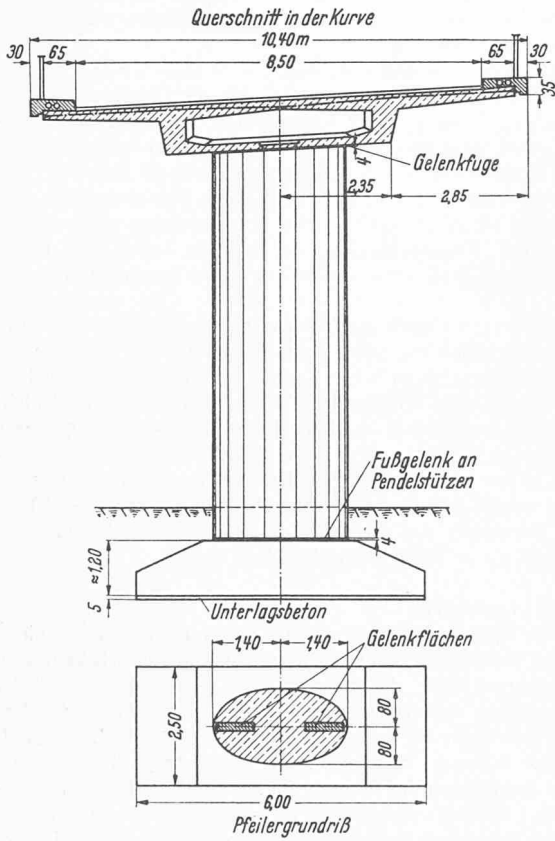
Querschnitt; Hohlkasten auf Pendelstützen
